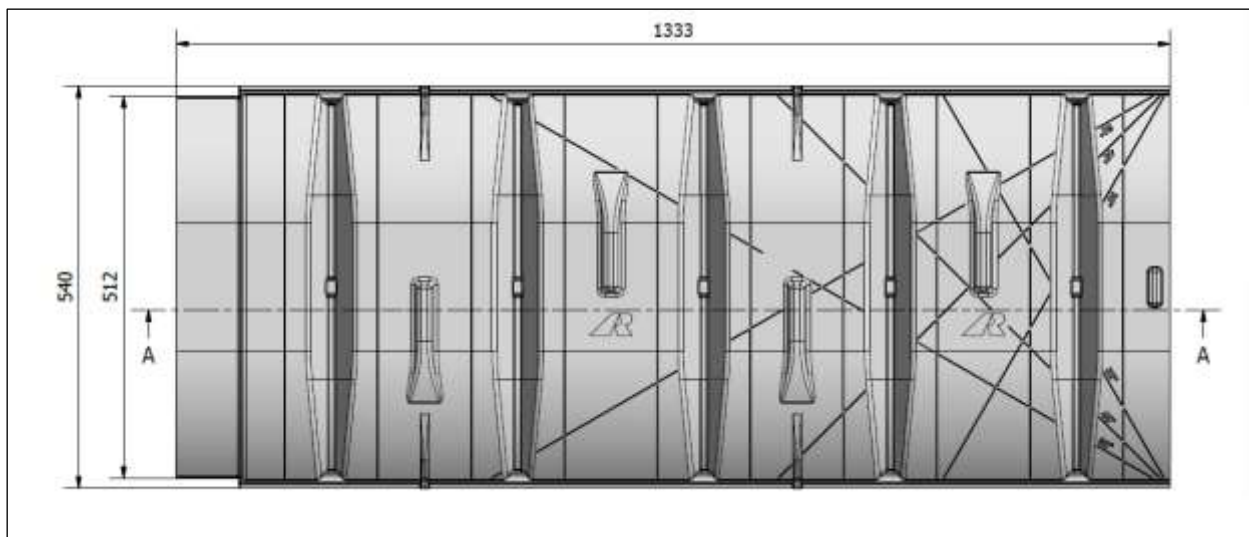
Coupe sur Neobois (longueur 1330 ou 1500 mm) hauteur coffrante 120 mm
